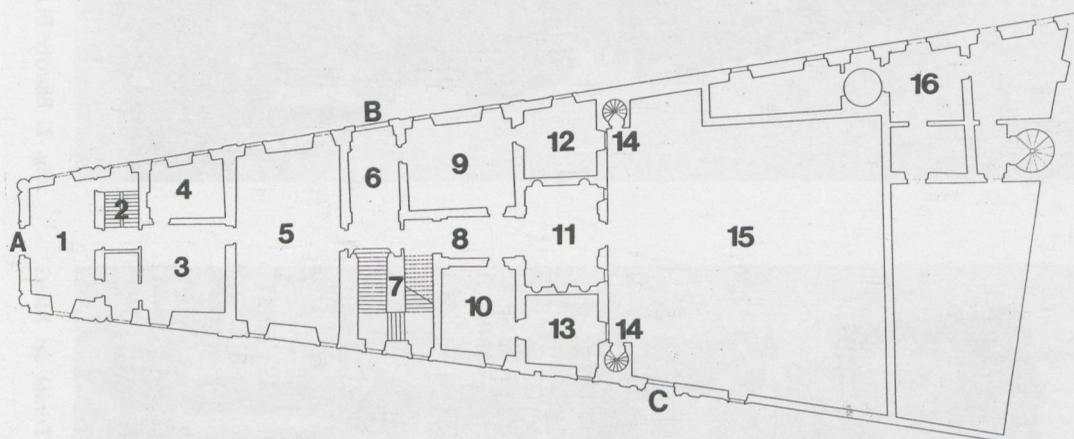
Roma, palazzo Zuccari. Ricostruzione dello stato originale della pianta del pianterreno.
